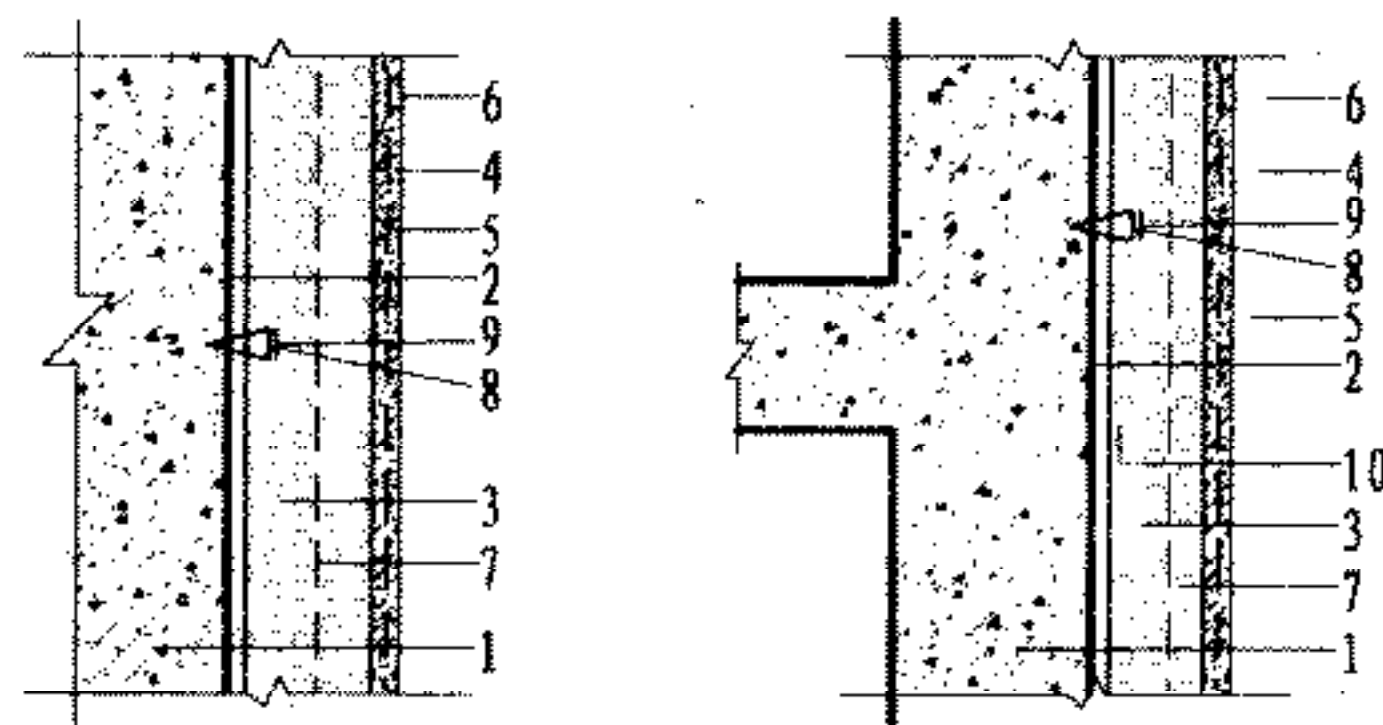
适用于钢筋混凝土外墙的EPG外保温系统
